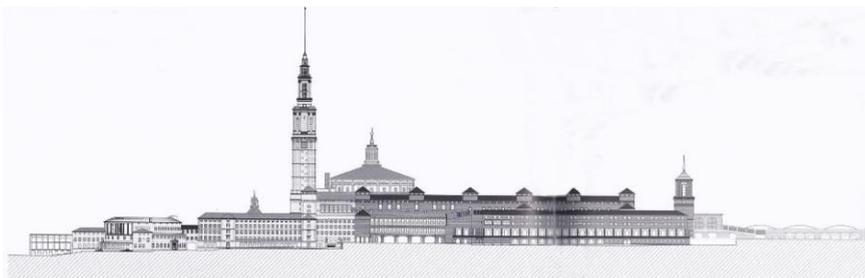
Alzado Sur del Conjunto (Agencia para el Desarrollo de Proyectos e Infraestructuras Culturales).
